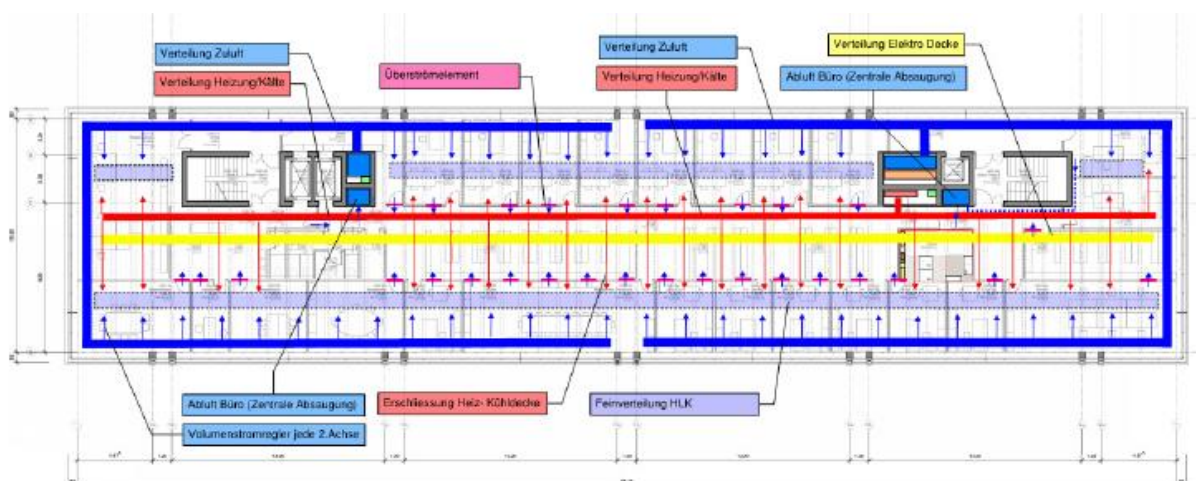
Exemplarischer Grundriss; Konzept der Gebäudetechnik
